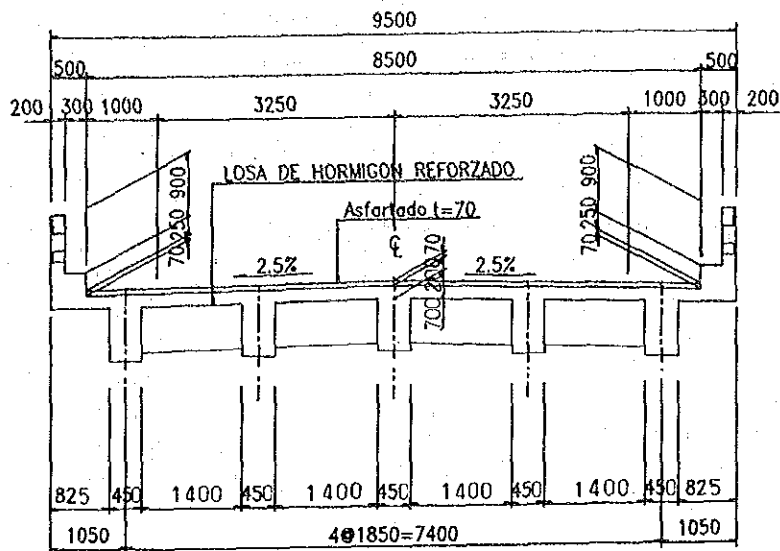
Vista en corte de la Viga T de Hormigón Armado (Viga T de HA)
